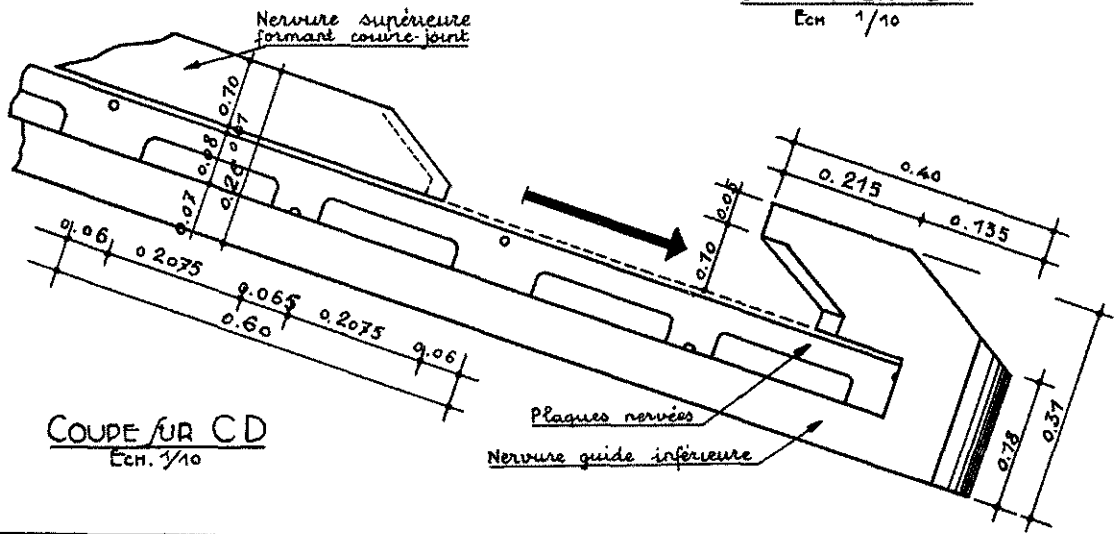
DÉTAIL D'ASSEMBLAGE DE PLAQUE SUR LE NERVURE
